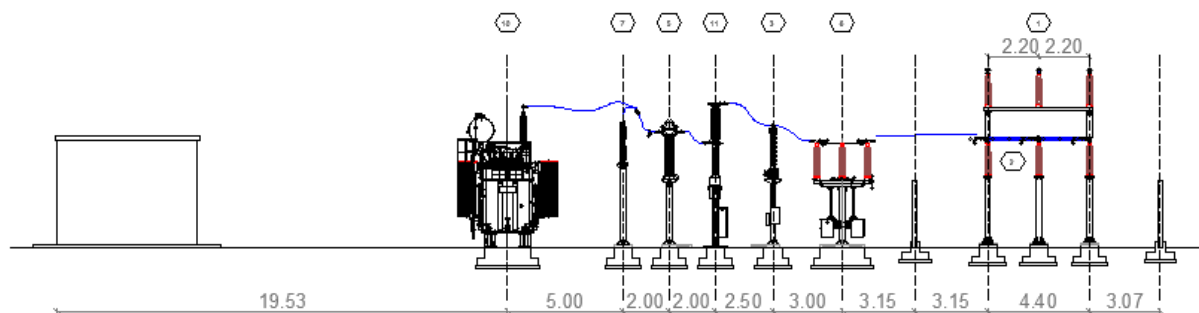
Sezione Longitudinale elettromeccanica stallo TR 30/150kV (SE Utente)
